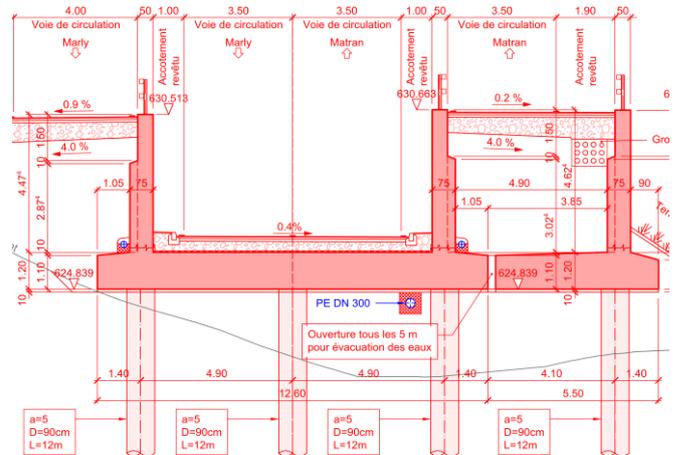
Coupe type de la trémie du PI Crausa avec mur adjacent
